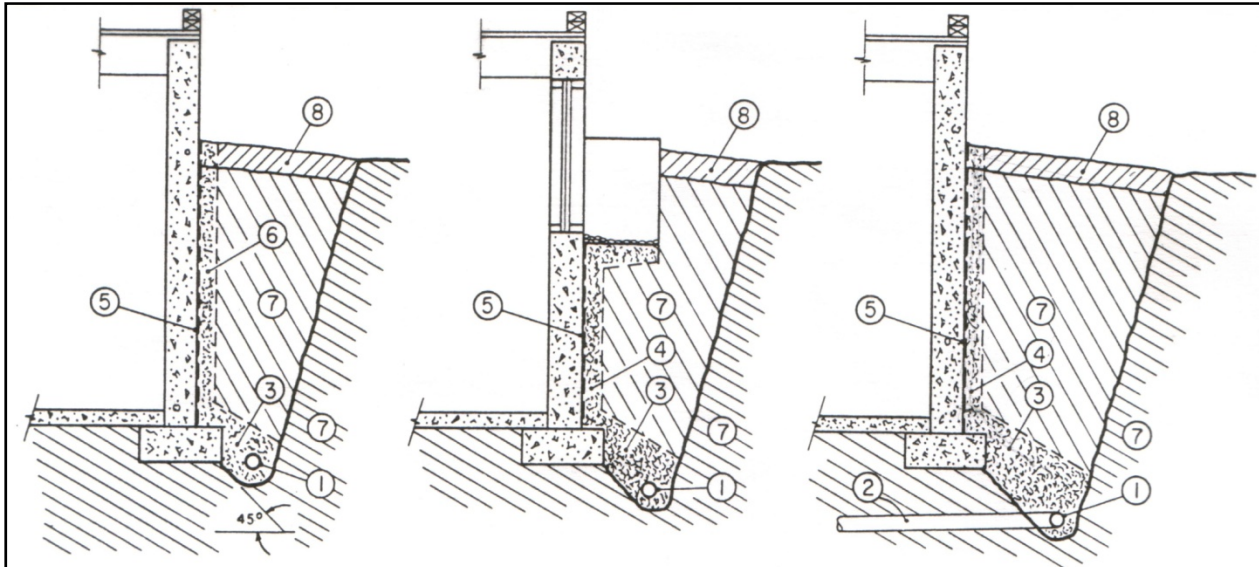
Section-type d'un système de drains souterrains autour d'une fondation superficielle.
